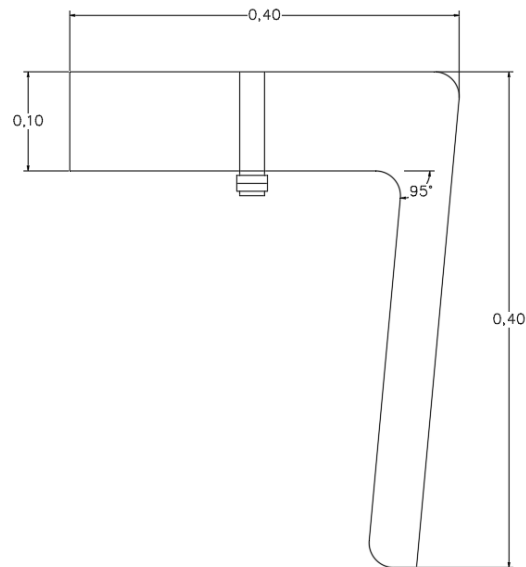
Imposta de hormigón armado. (Fuente: Elaboración propia en AutoCAD).
